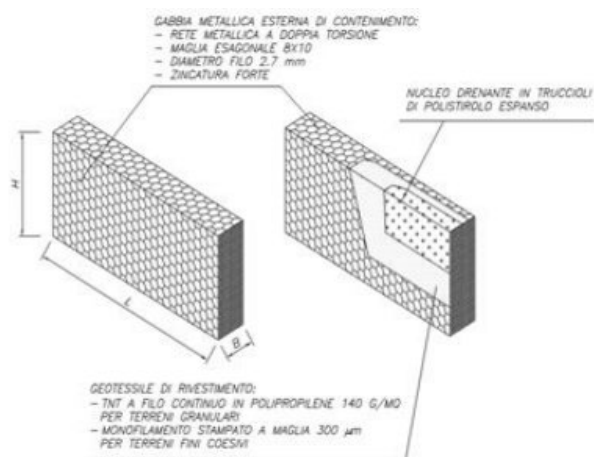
Particolare del sistema - Assemblaggio a piè d'opera delle trincee drenanti
